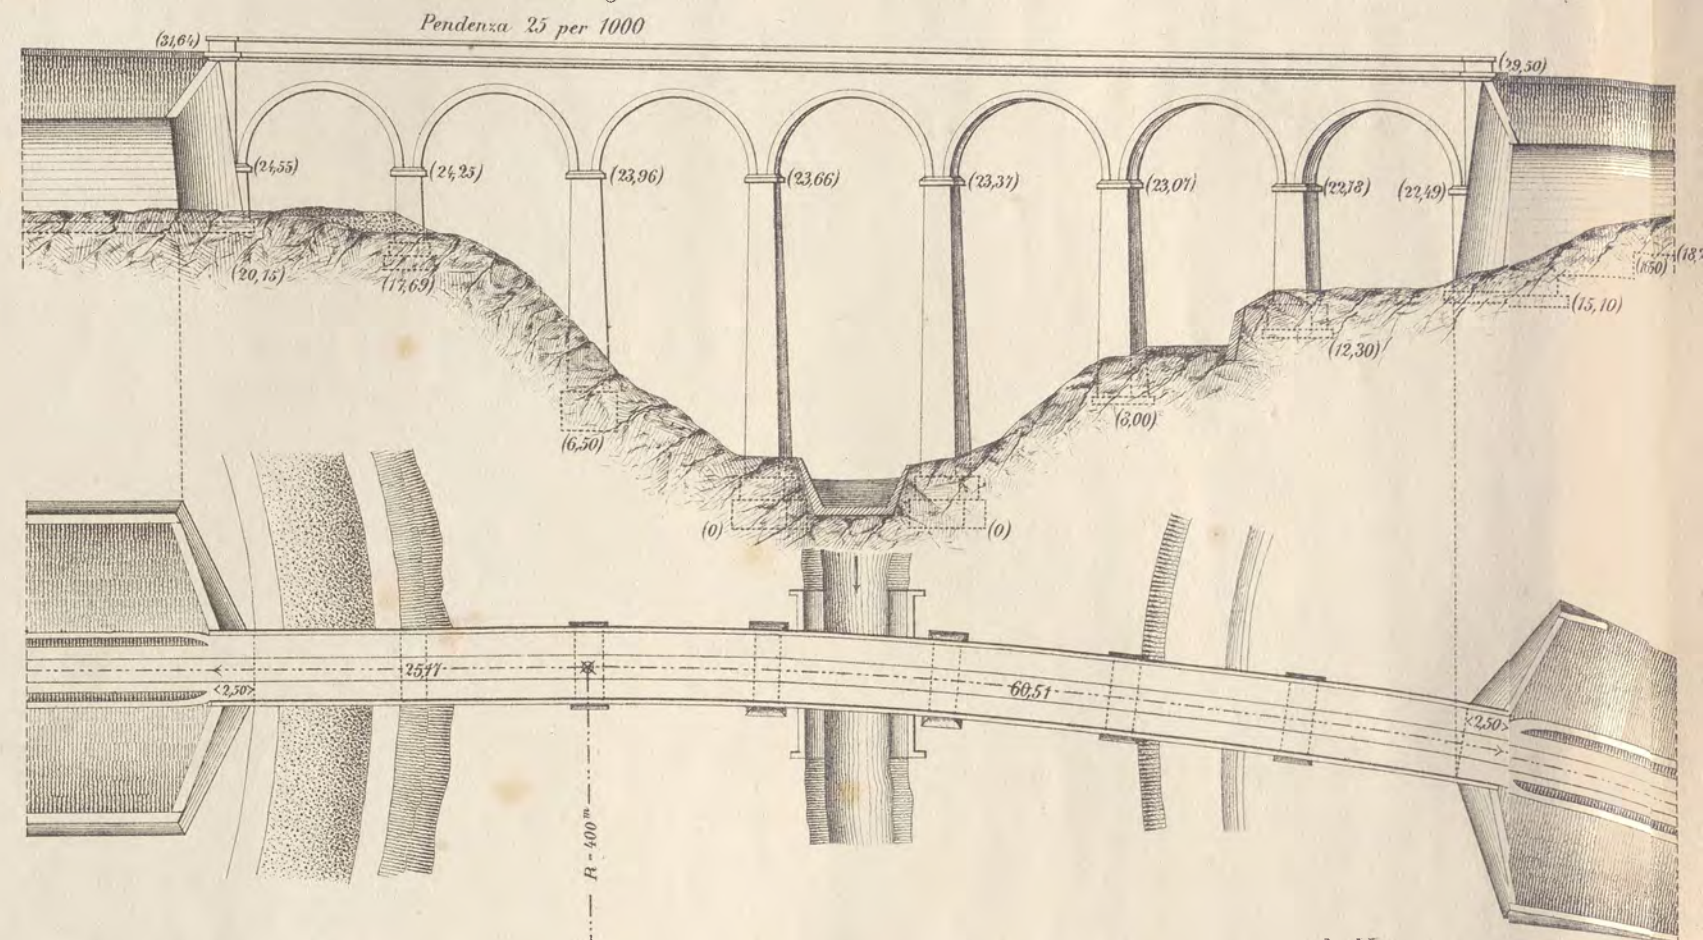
<sup>a</sup> Sezione longitudinale e pianta (supposto tolto il terreno) di un' estremità del Viadotto.
